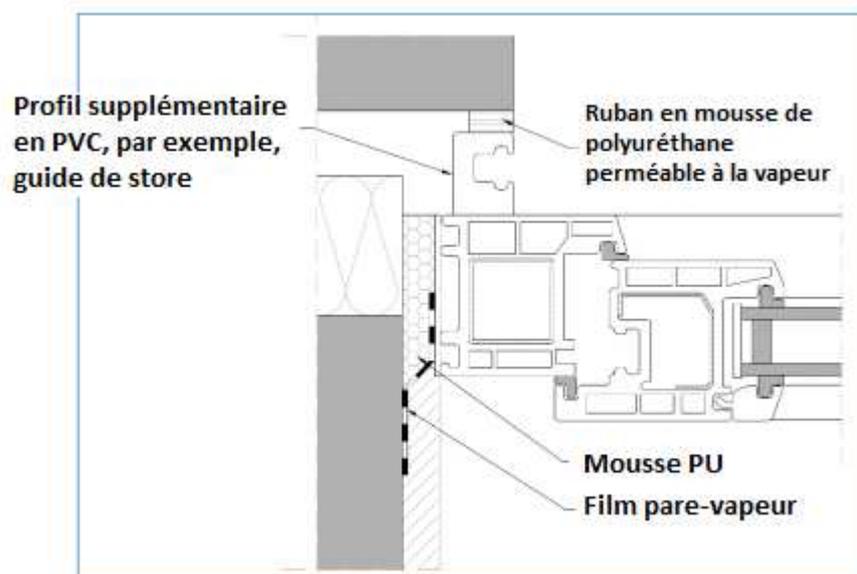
Exemple d'étanchéité du joint latéral entre une fenêtre PVC et l'ébrasement.
